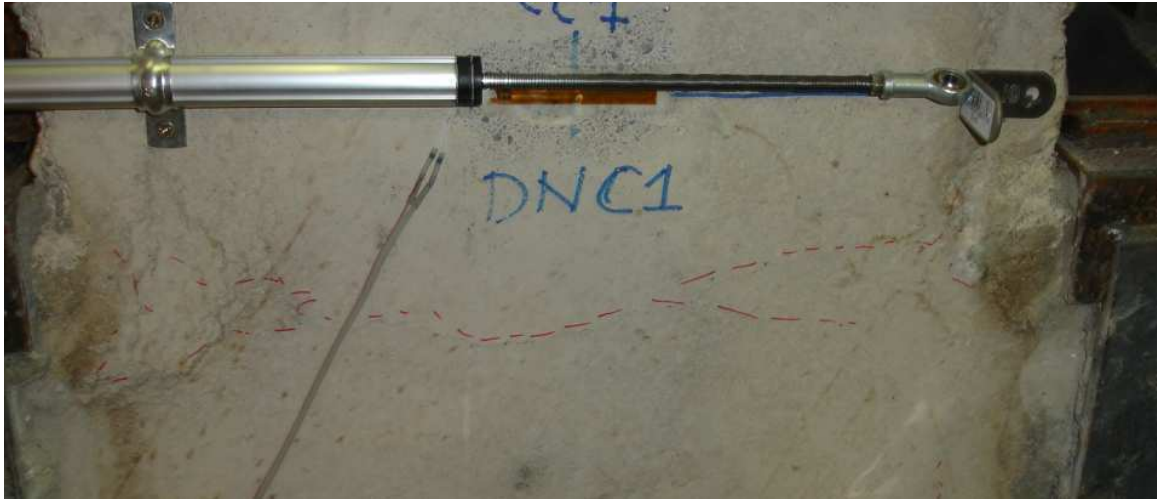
Fisuración aparecida en la cara de compresión en las probetas RC-L1
